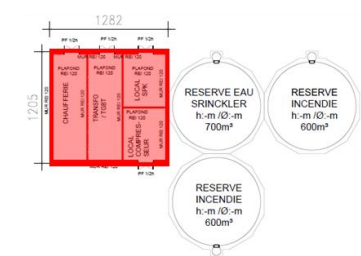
Plan des murs coupe-feu de l'entrepôt
